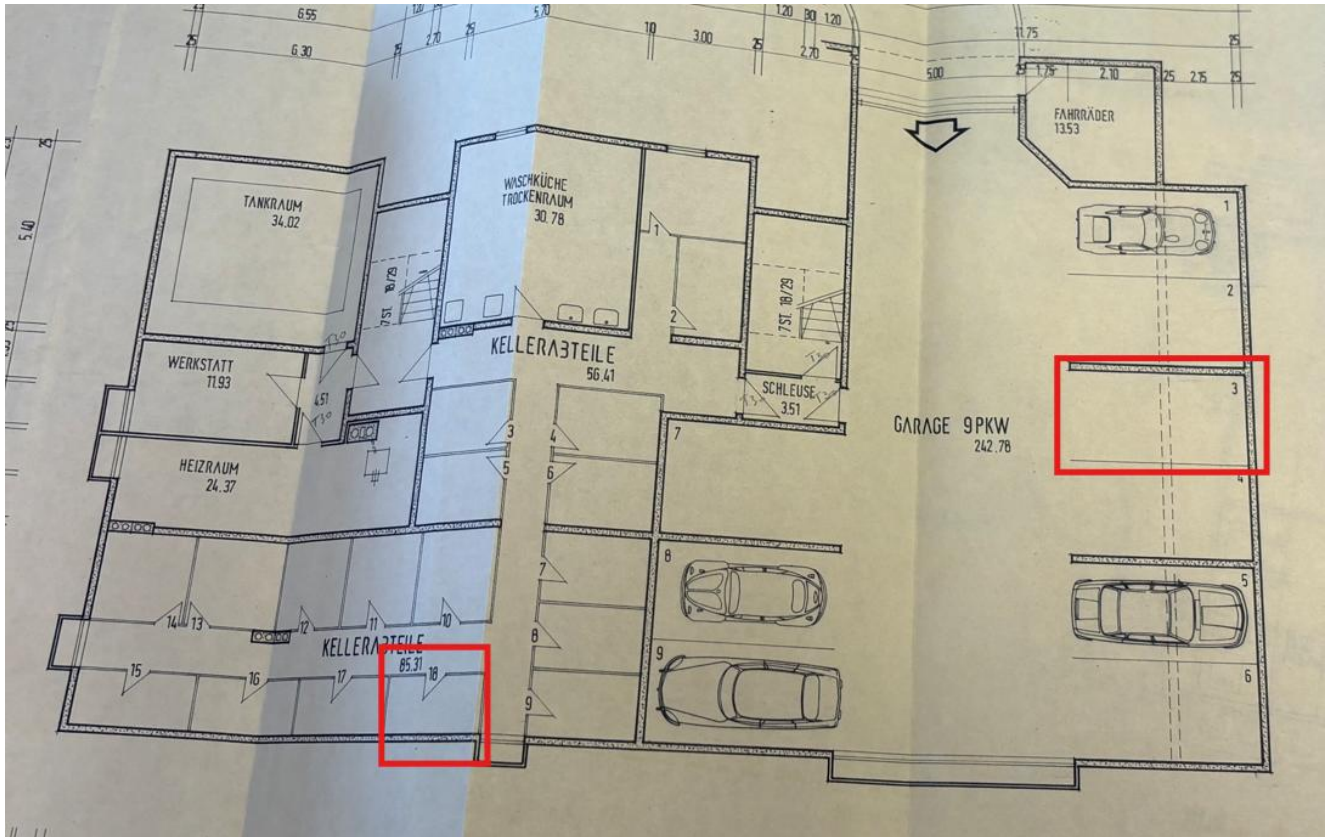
Grundriss Autoabstellplatz A 27 und Kellerabteil gem. Tekturplan vom August 1979
